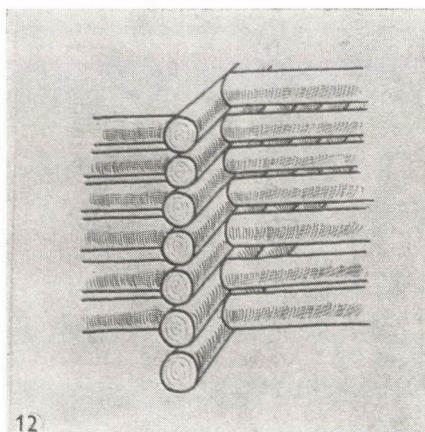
Rekonstruktion des Holzgerüsts des Soproner roten Walles auf Grund der beim Haus Templom u. 23 angestellten Beobachtungen
